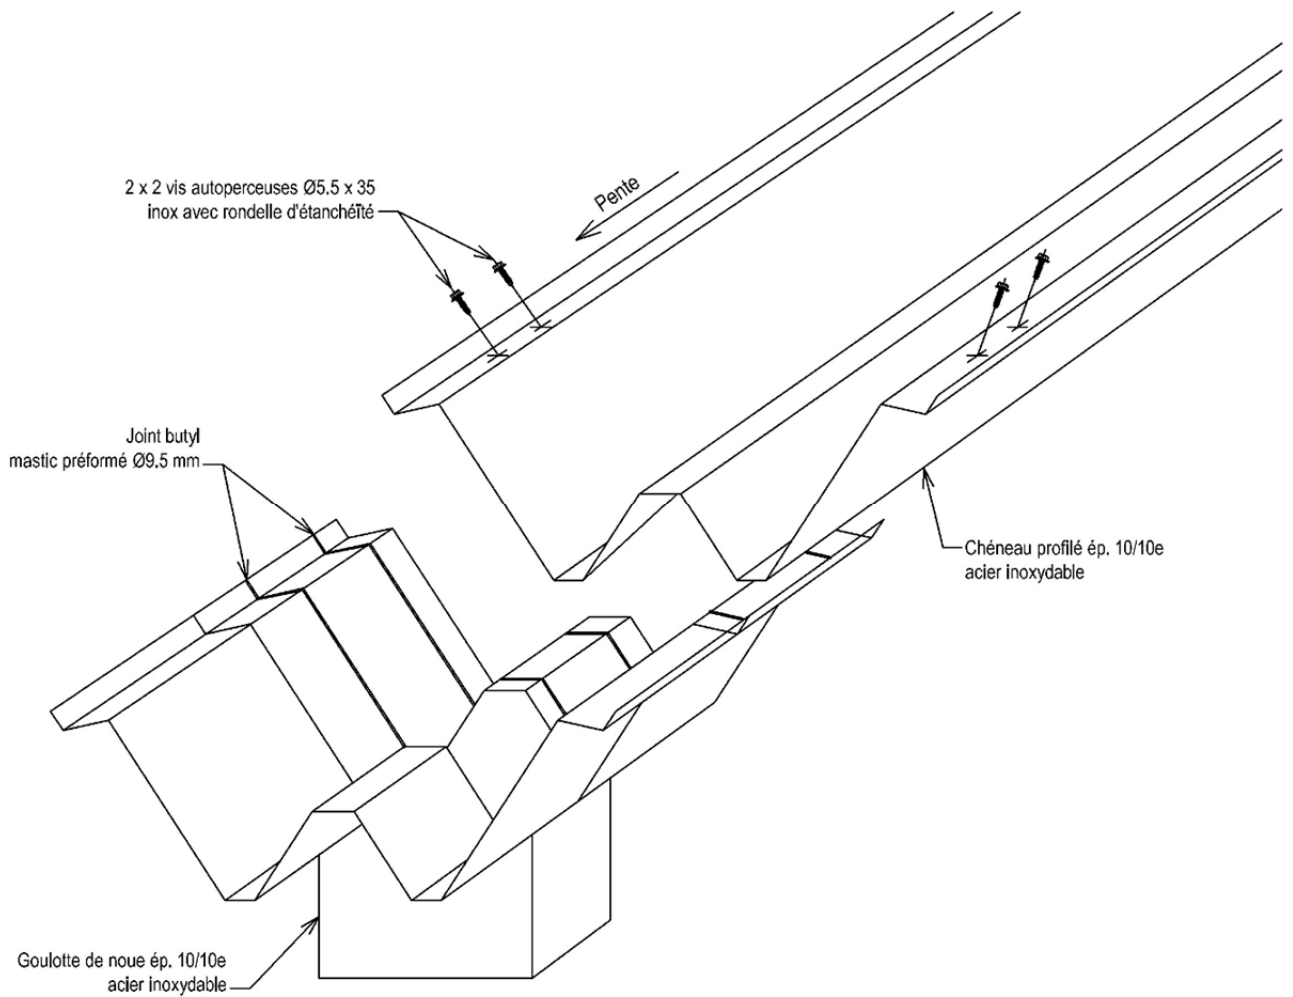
Détail de raccordement des chéneaux en bas de pente (file centrale)
